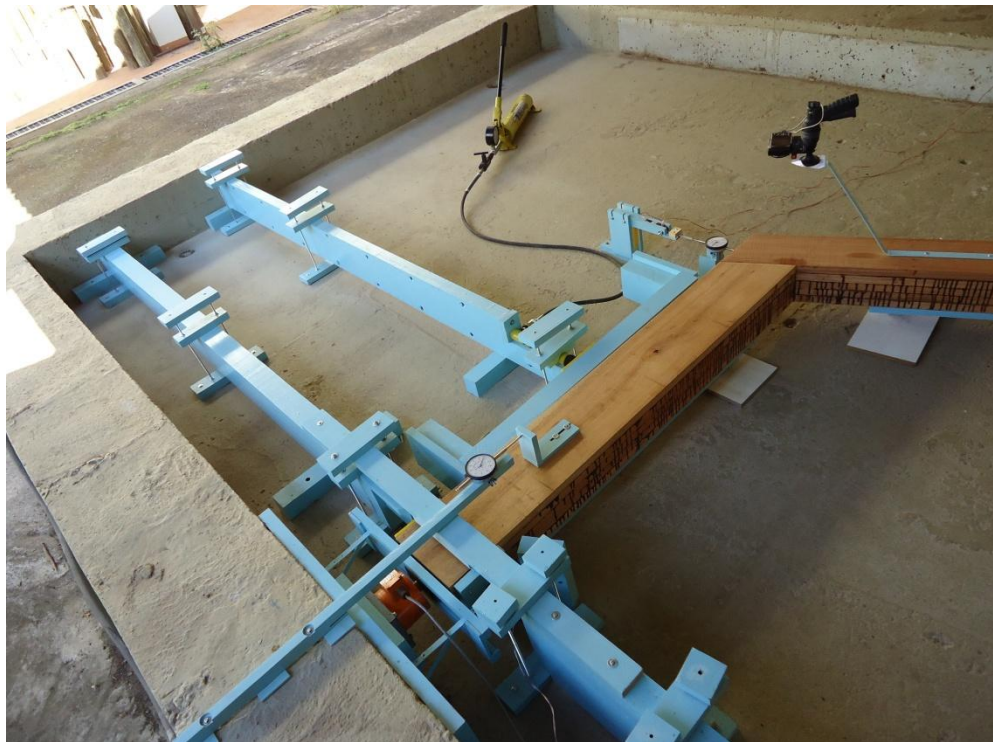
Detalhe da aplicação da carga lateral e do posicionamento da célula de carga sob o pilarete.
